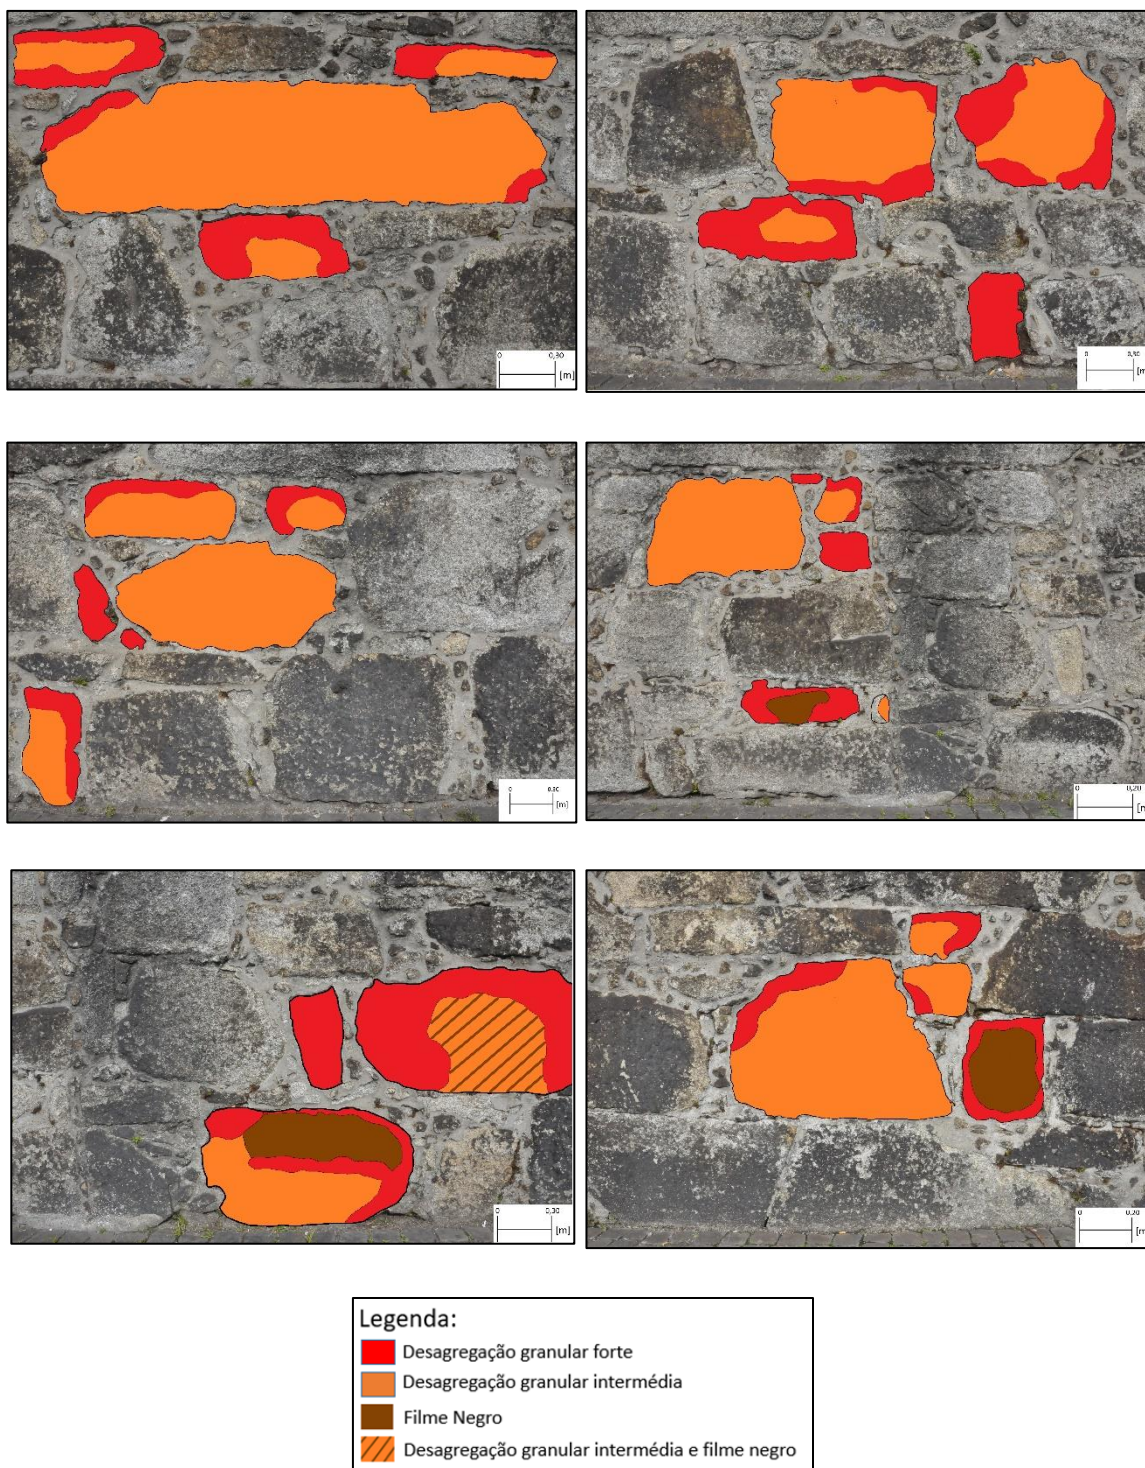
Cartografias das deteriorações em setores do muro de suporte da fachada Sul do Hospital de Santo António
